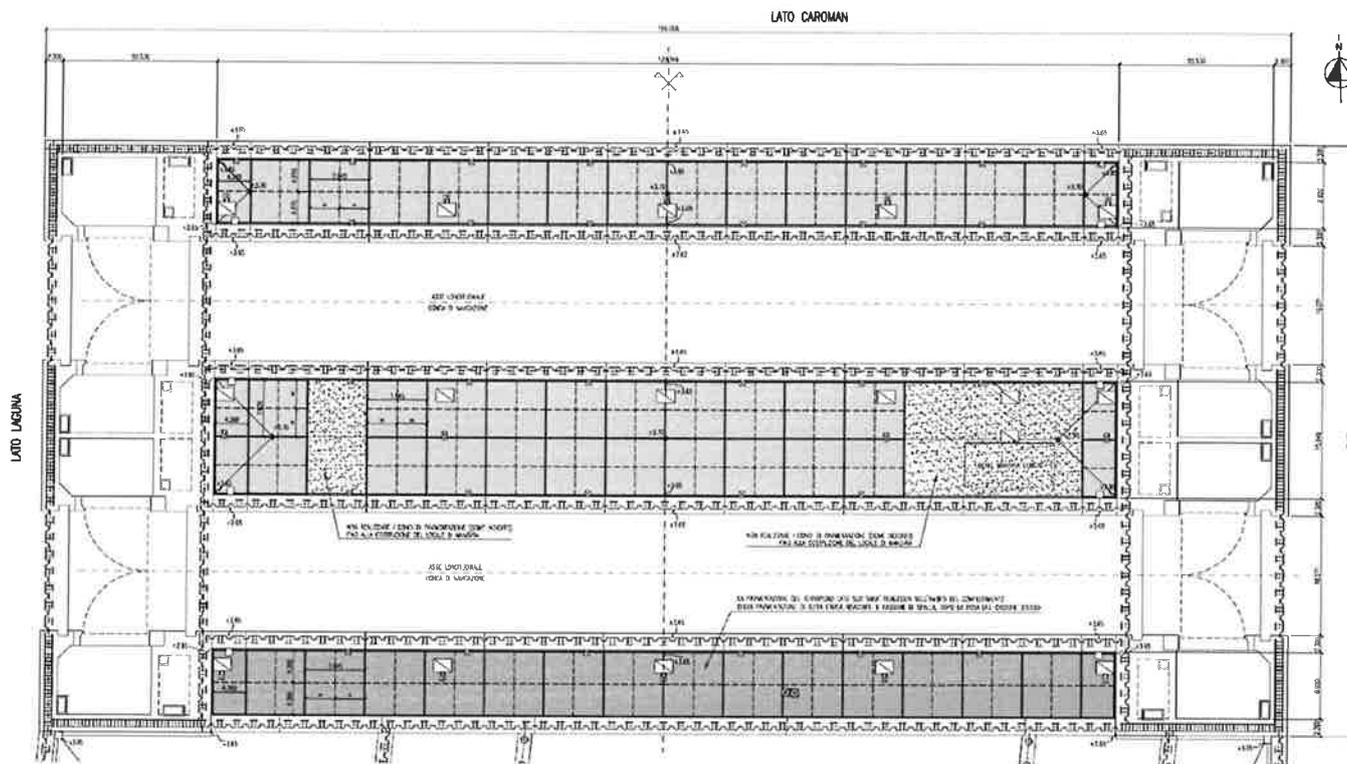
CONCHE DI CHIOGGIA – PLANIMETRIA DELLE CONCHE – STATO DI FATTO AL TERMINE DELLA WBS CH.E1.10
